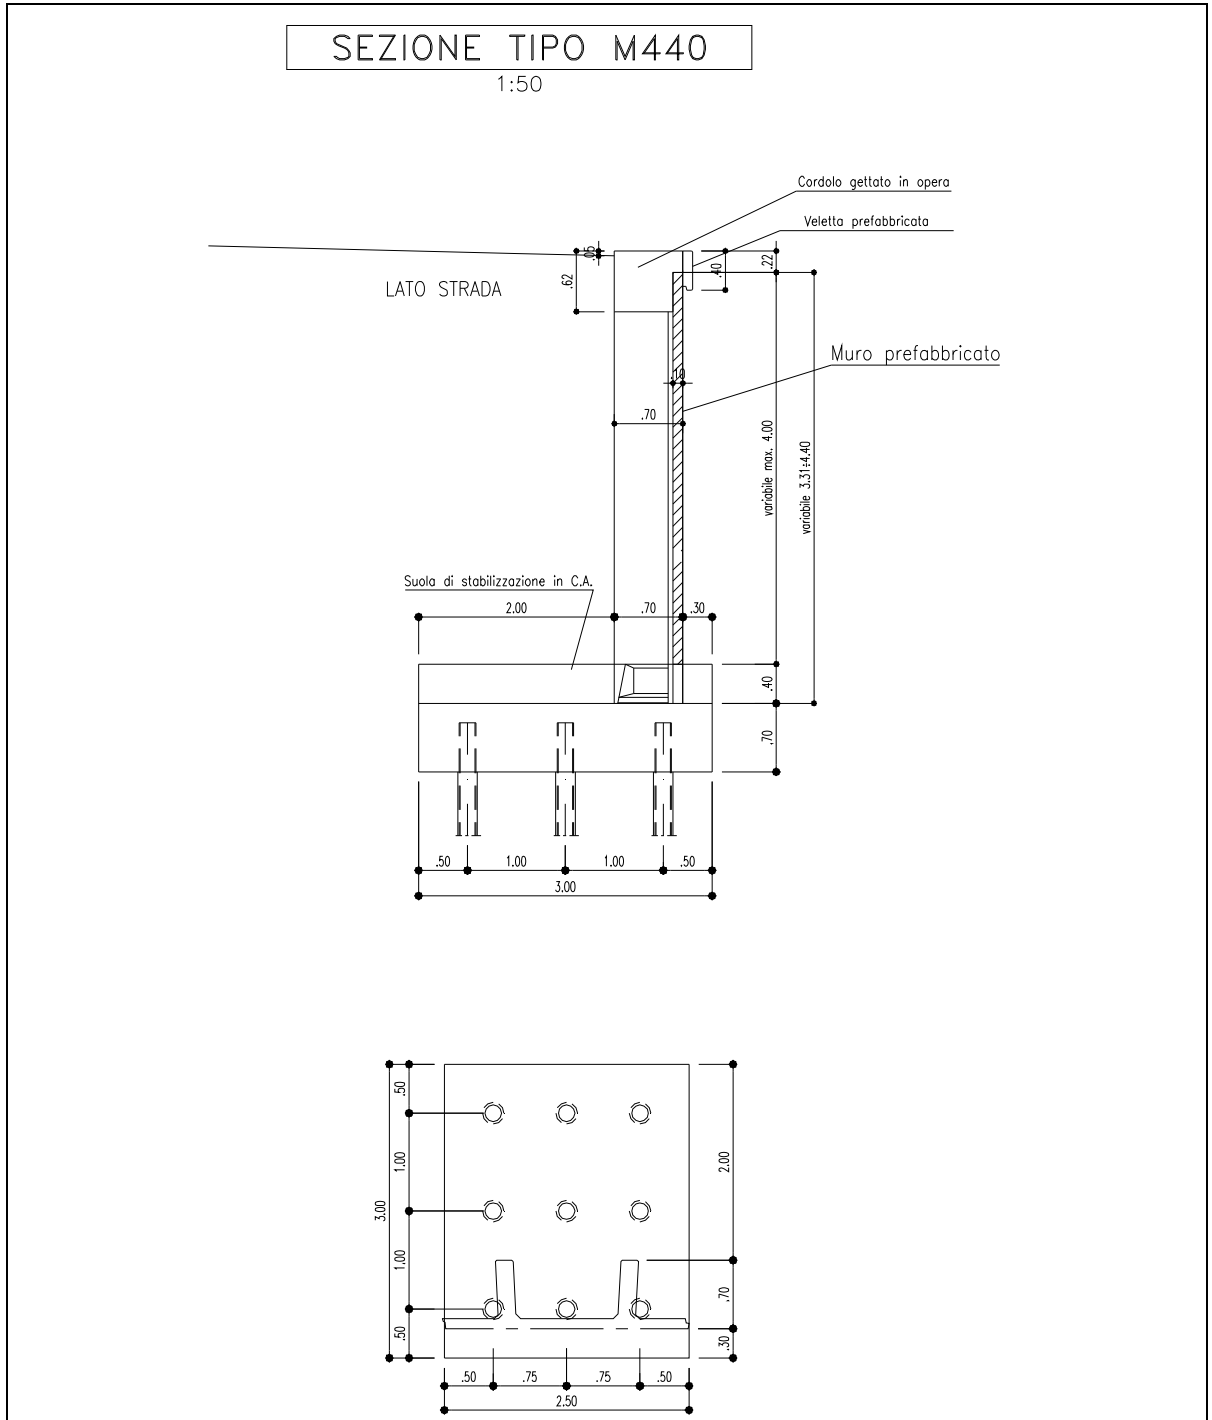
Sezione – Tipo muro su micropali H 4.0 m
